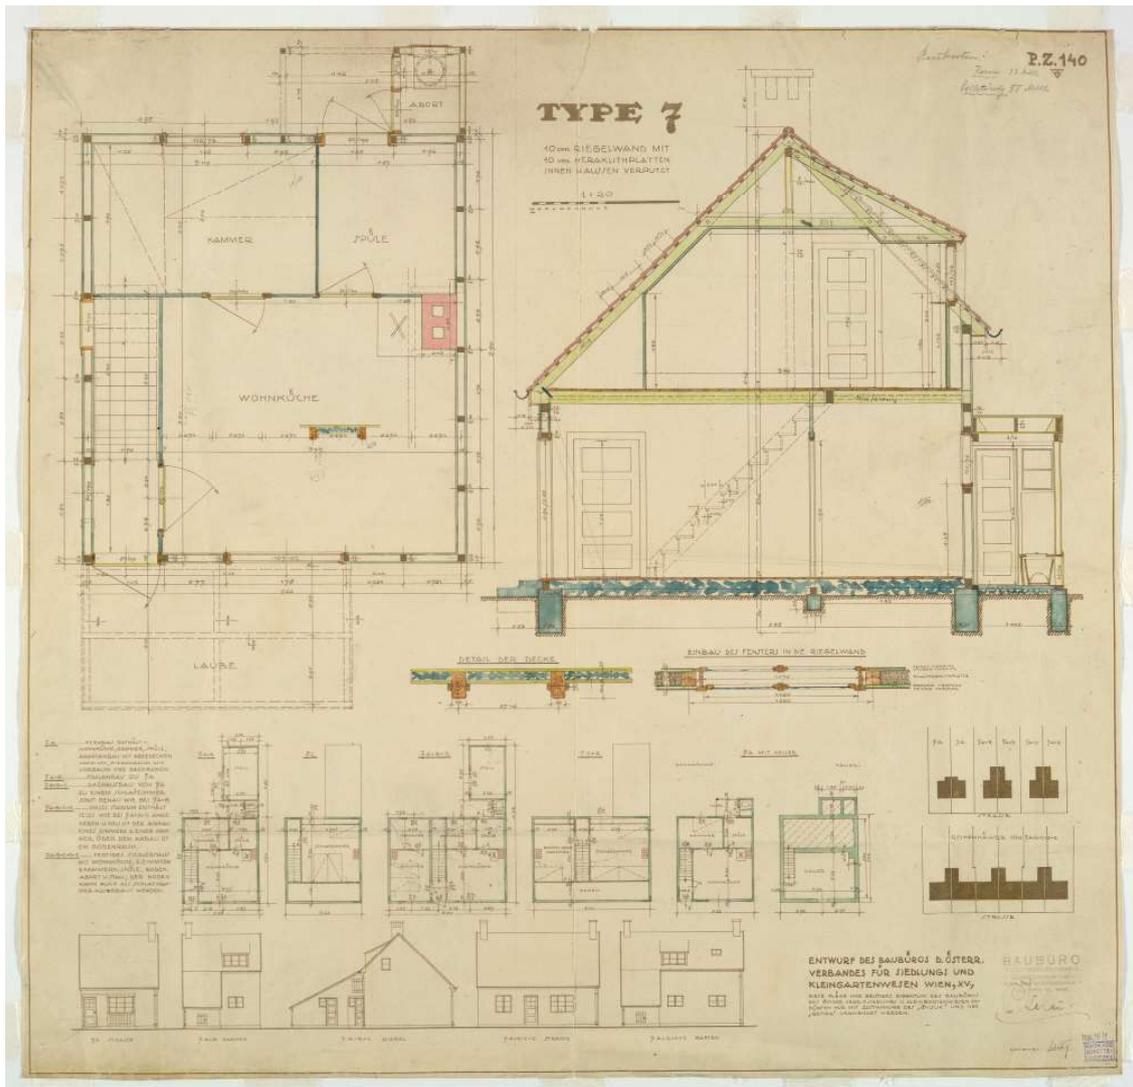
Abb.IX:Kernhaus Type 7, Grundrisse, Ansichten und Schnitt.
